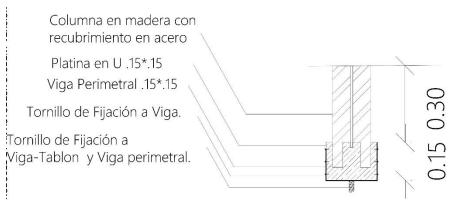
Detalles constructivos, uniones, de piso a columna.
